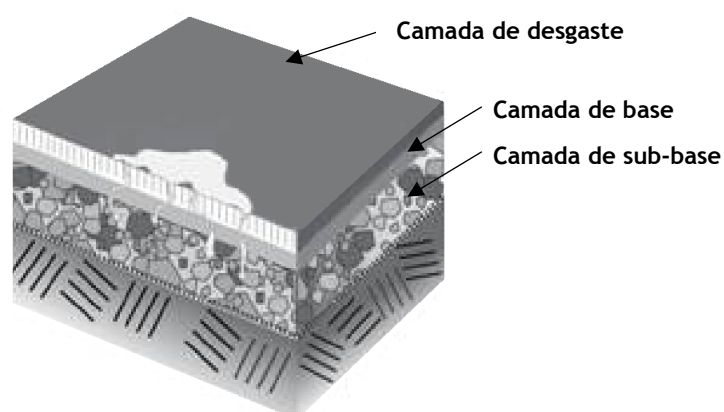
Representação esquemática de pavimento com as três camadas fundamentais. (adaptado de Drainage Design Manual, 2009)
